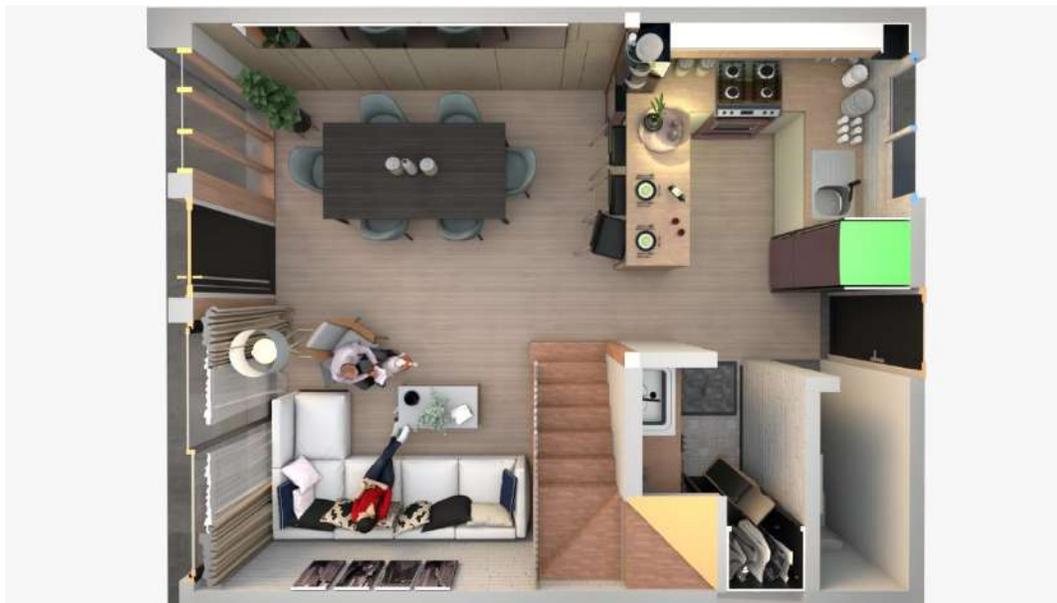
Vista en planta del primer nivel. Fuente: Propia.
